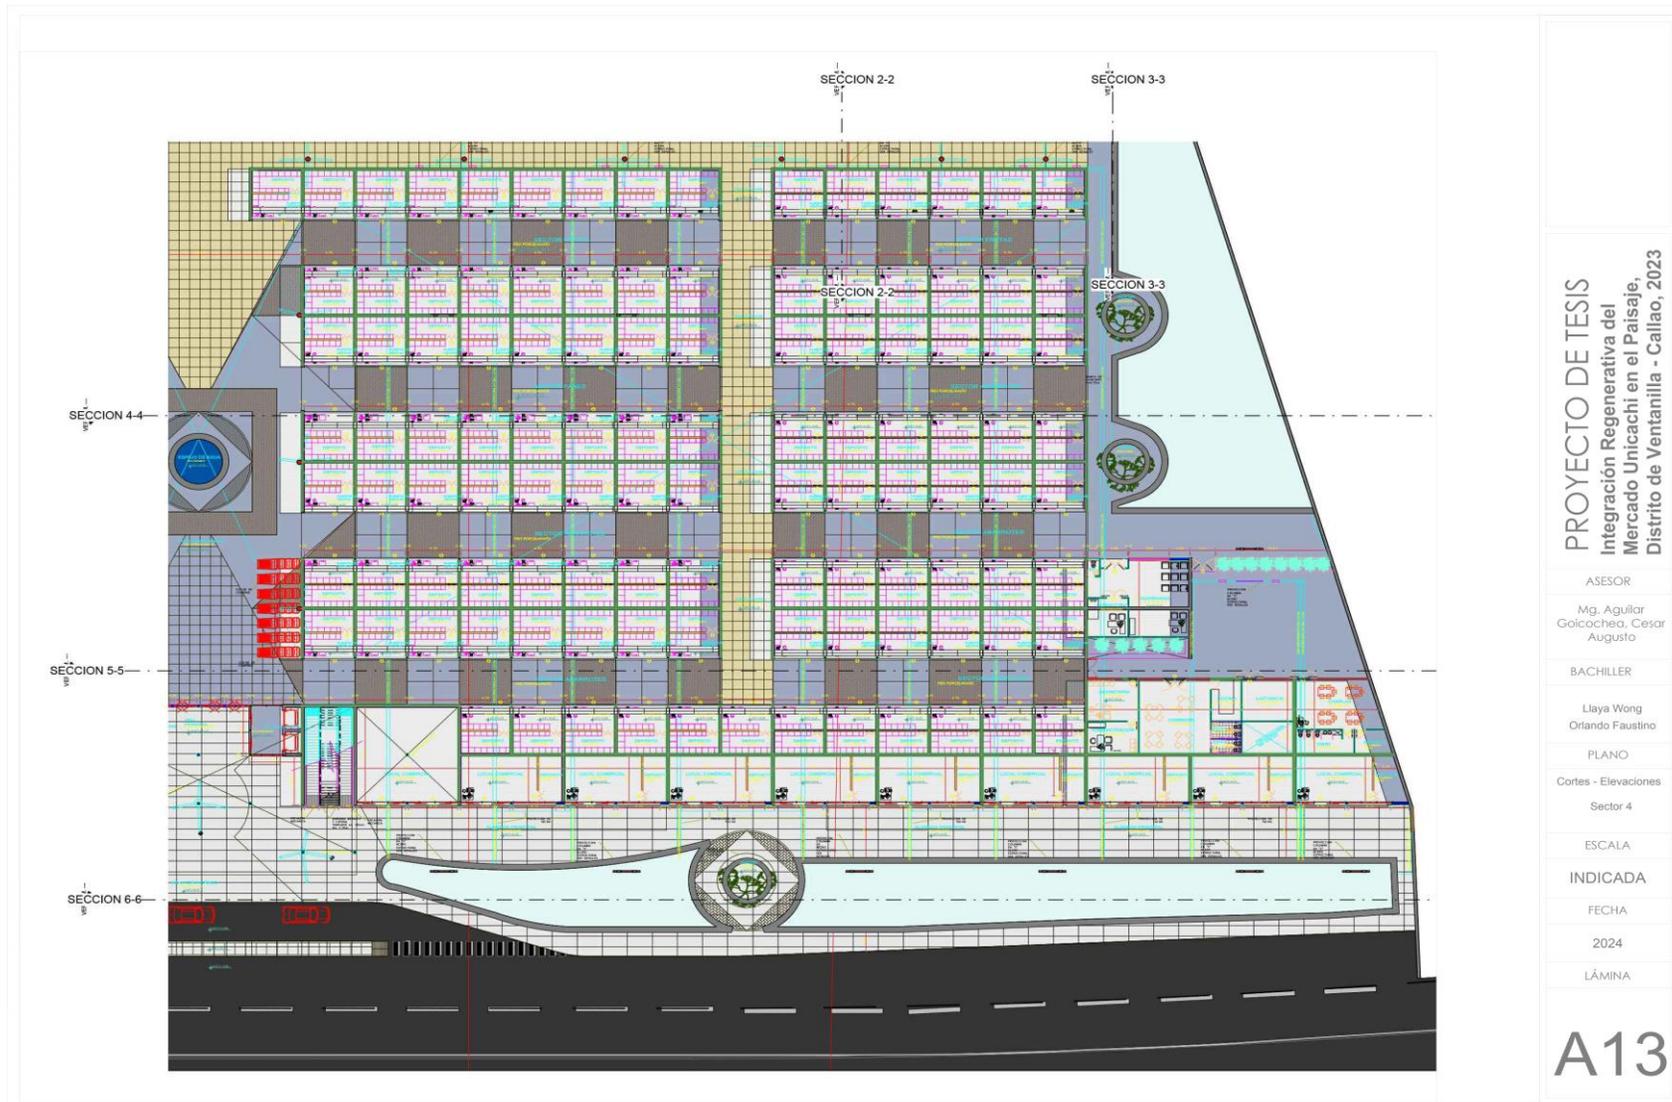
Plano de distribución por sector 3- cortes elevaciones, elaboración propia.
